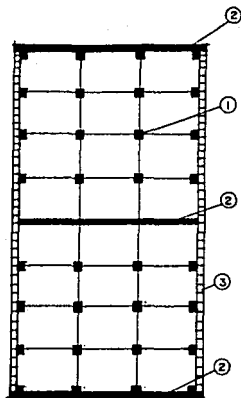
Muro de relleno por medio de un encamisado (Ref.15)
